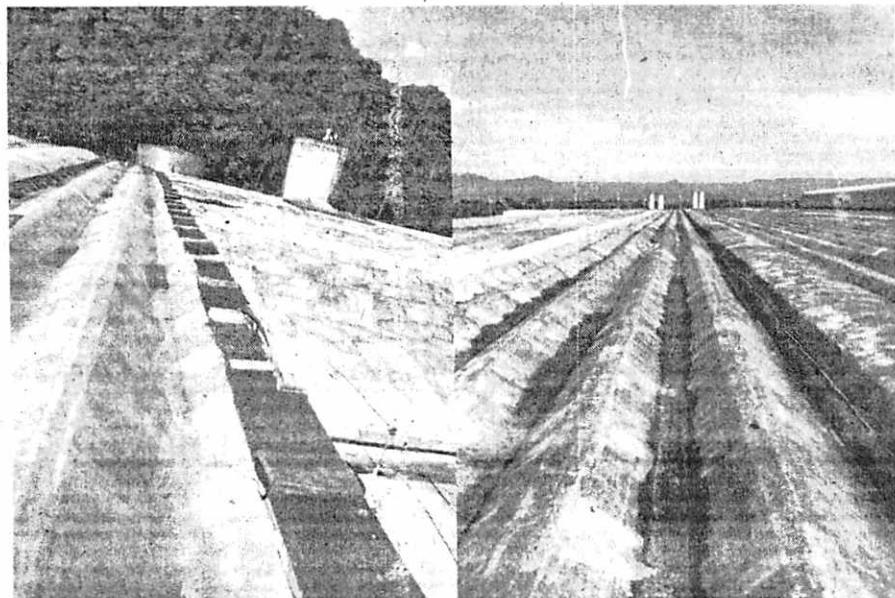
Vista geral do telhado do super mercado – telha tipo canaletão, com a vigas calhas para a coleta e condução das águas pluviais.
